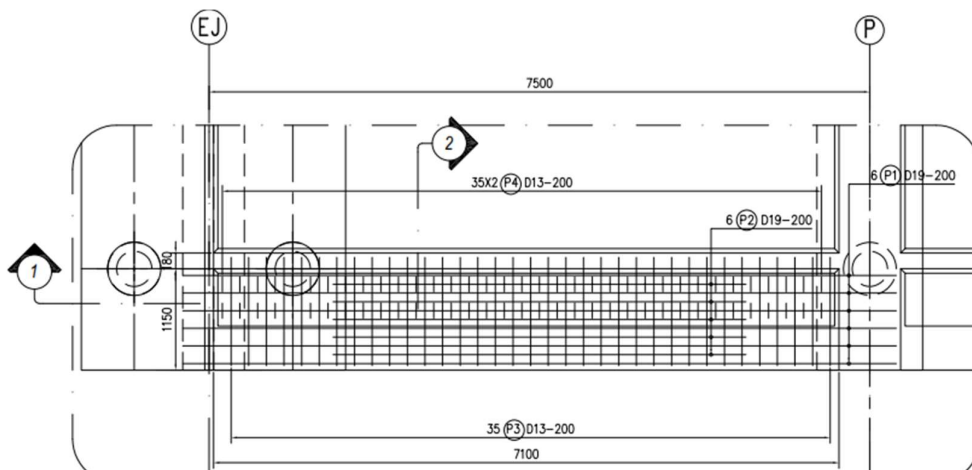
Detail Penulangan *Half Slab* Tebal 35 Cm
